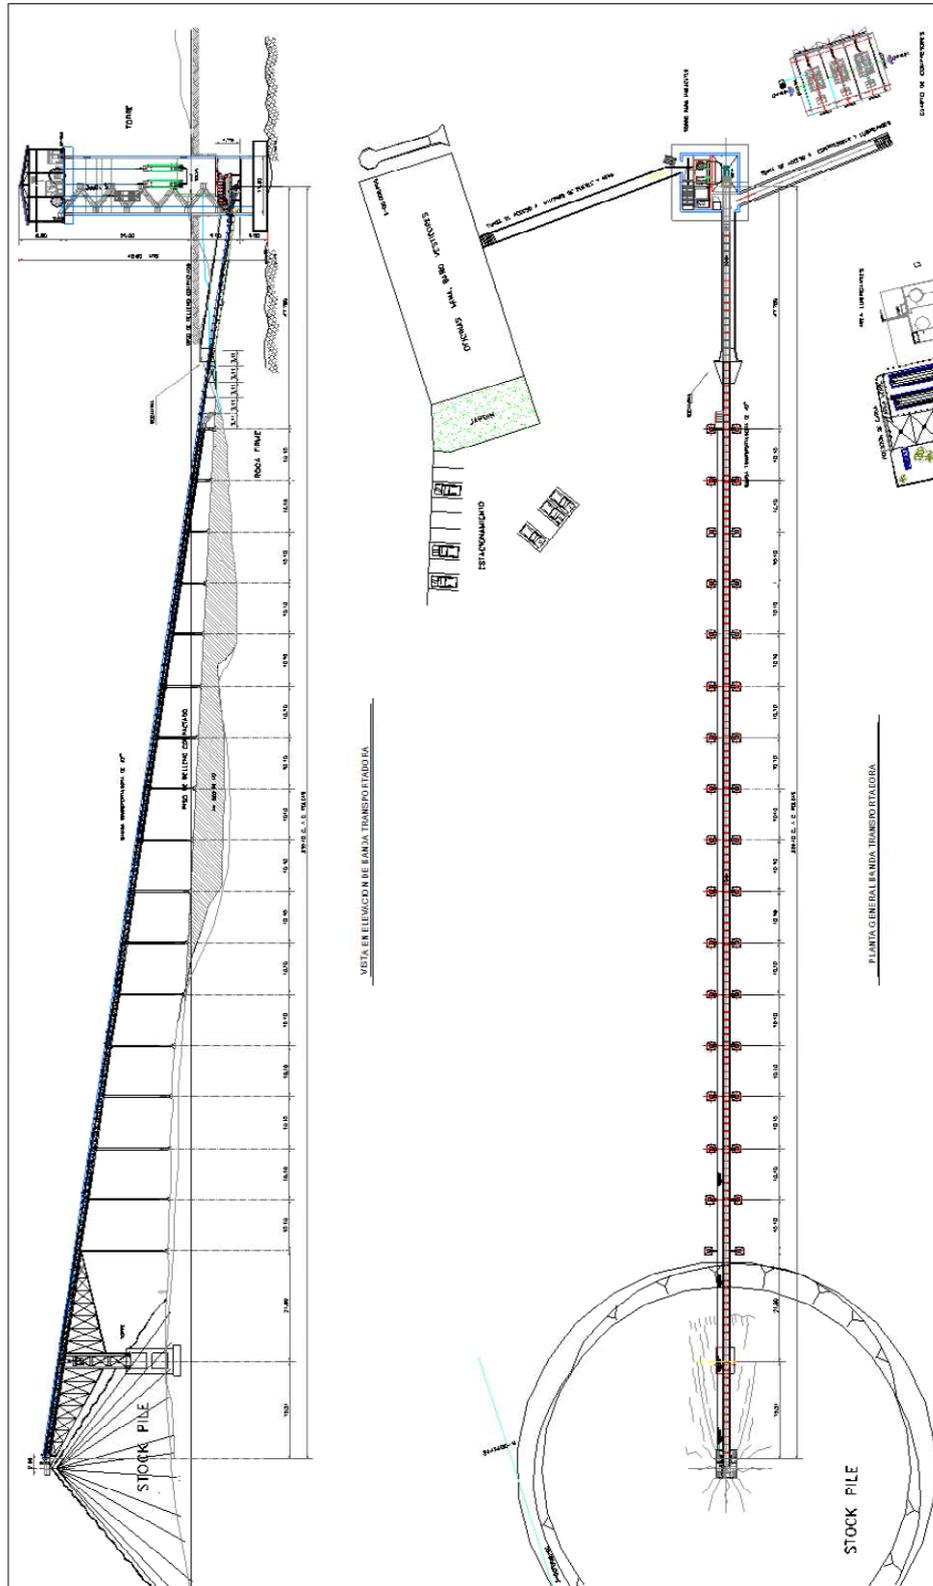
Vista en sección y planta de las instalaciones del malacate y el stock pile.
